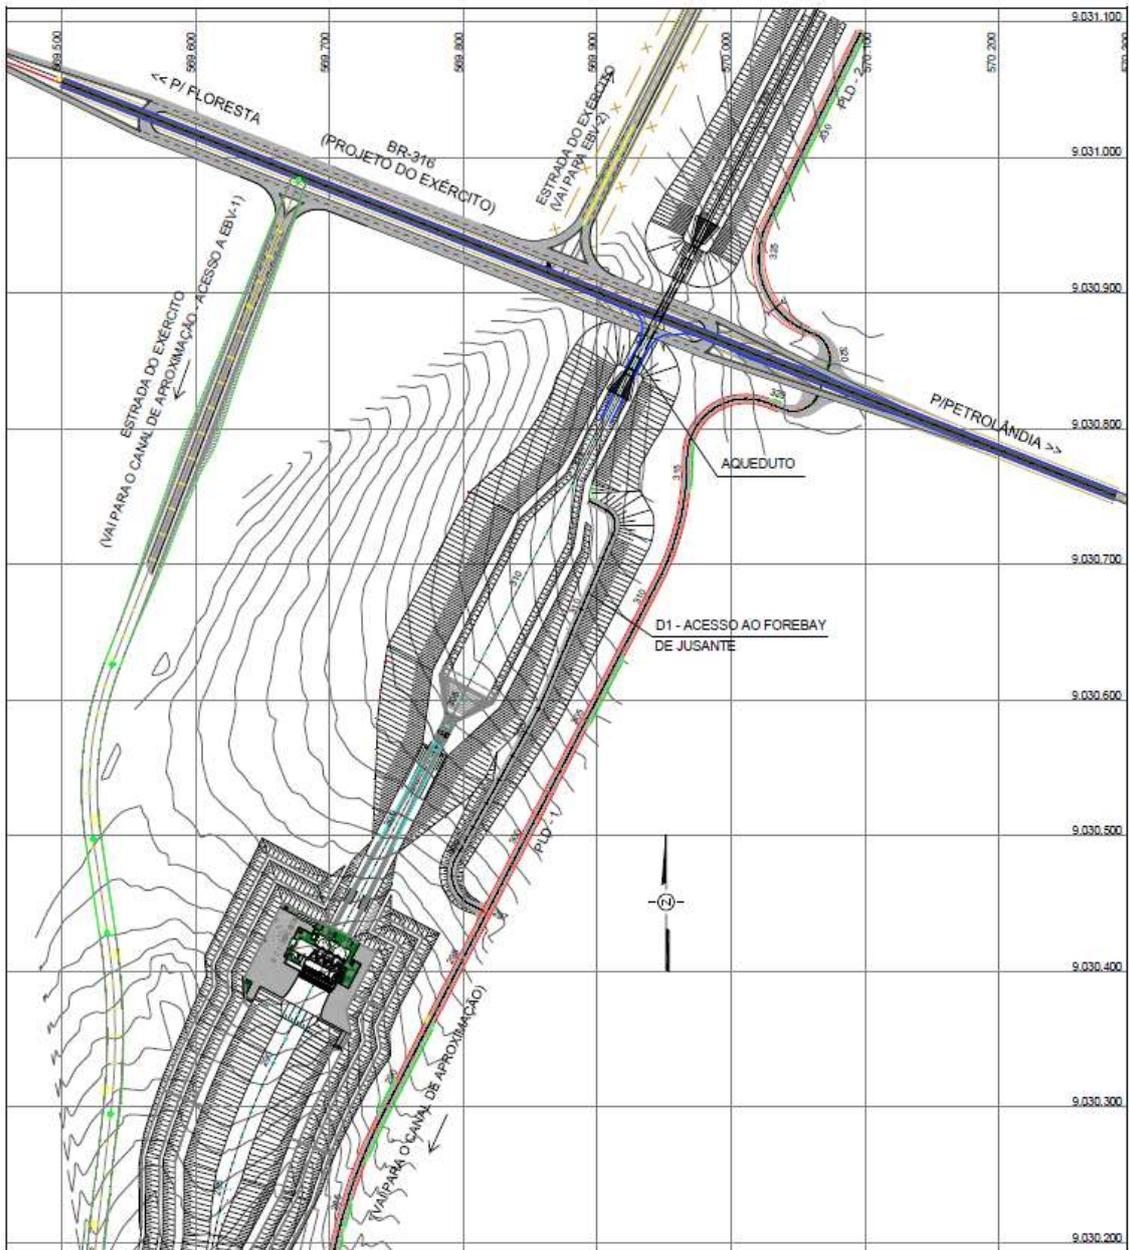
Planta Baixa da EBV-1 – Arranjo Geral
